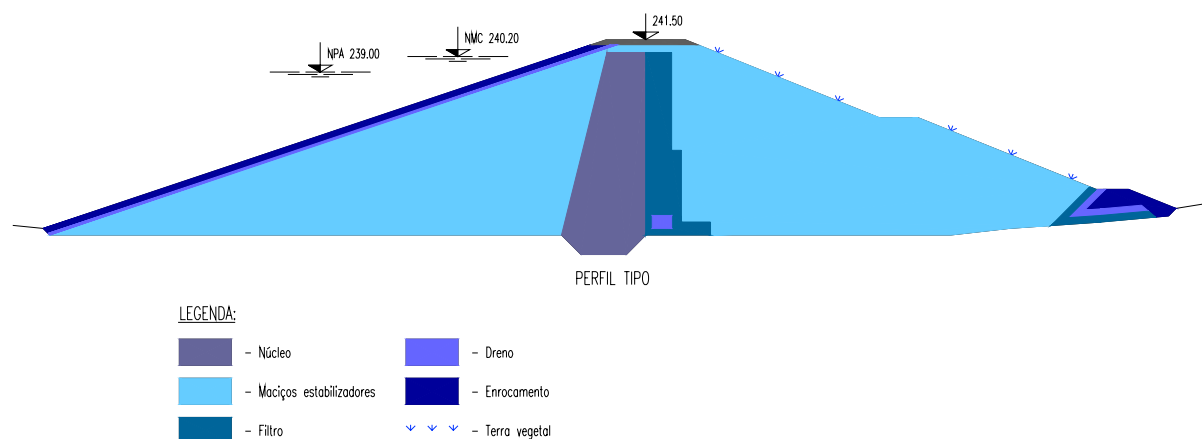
Perfil tipo da barragem do Pessegueiro.
